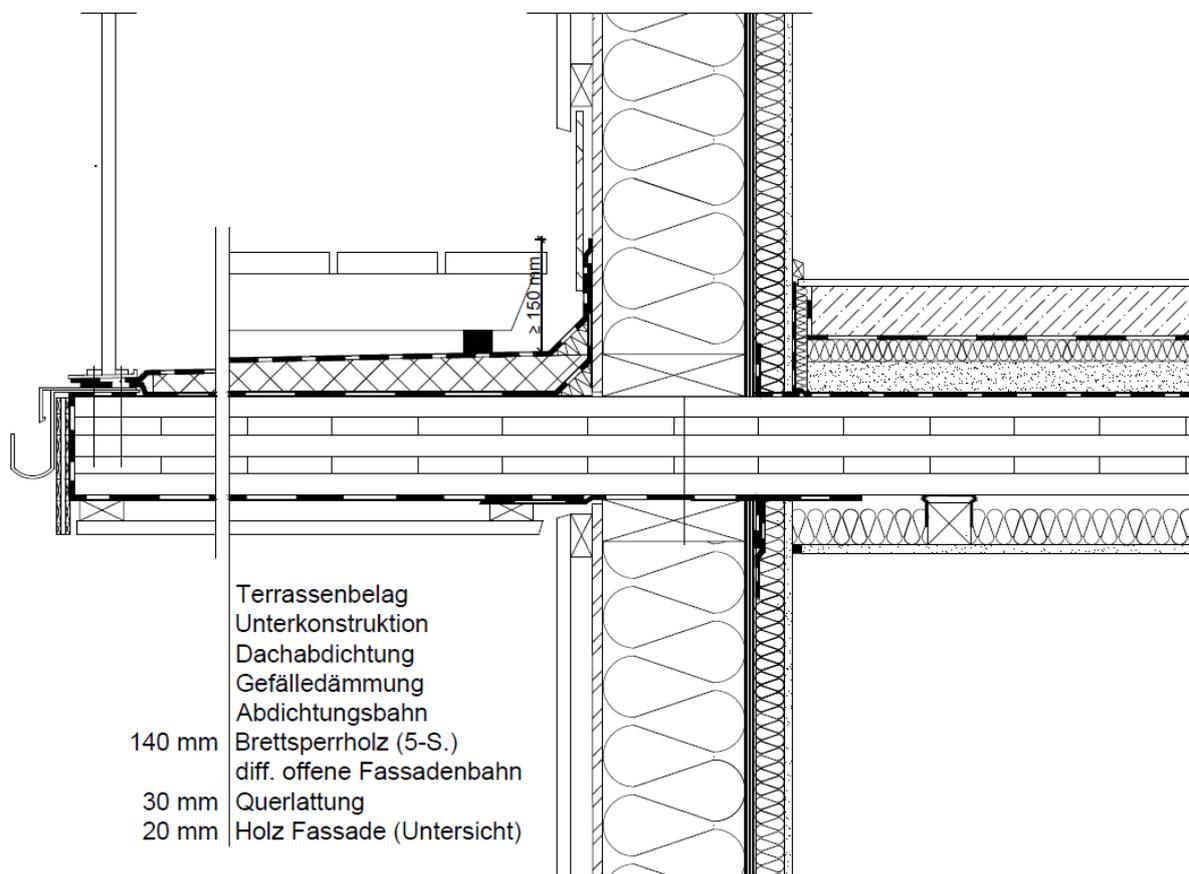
Anschlussdetail Auskragende BSP Deckenplatte (gdmnxa01a) – Außenwand (Holzrahmenbauweise) (arhi01a-03)
